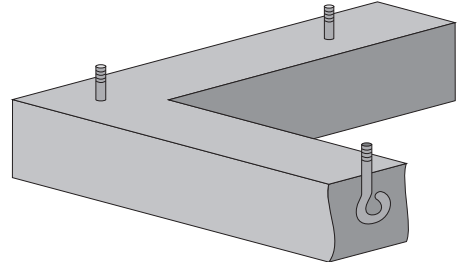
Фрагмент ленточного фундамента с анкерными выводами
